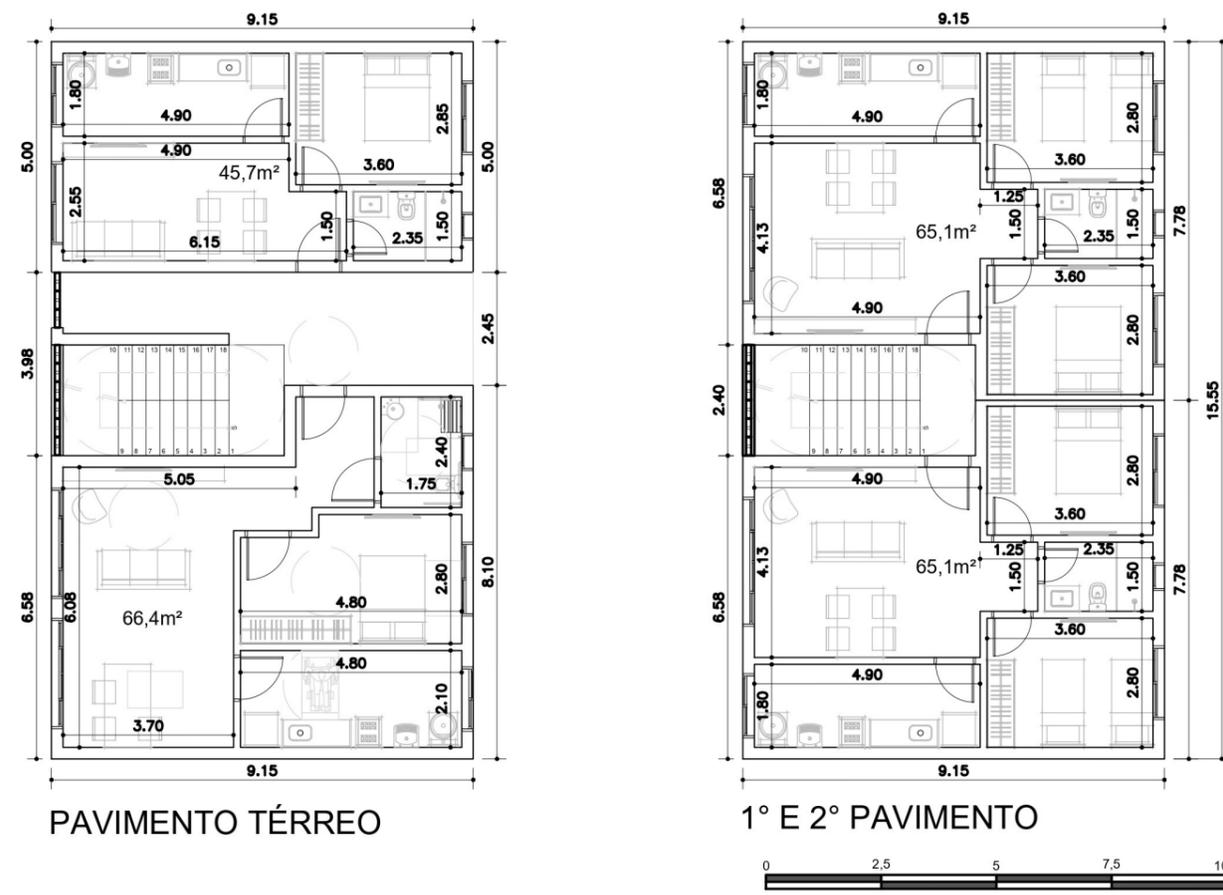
PLANTAS BAIXAS DO NÚCLEO HABITACIONAL COM UNIDADE ACESSÍVEL COTADAS
